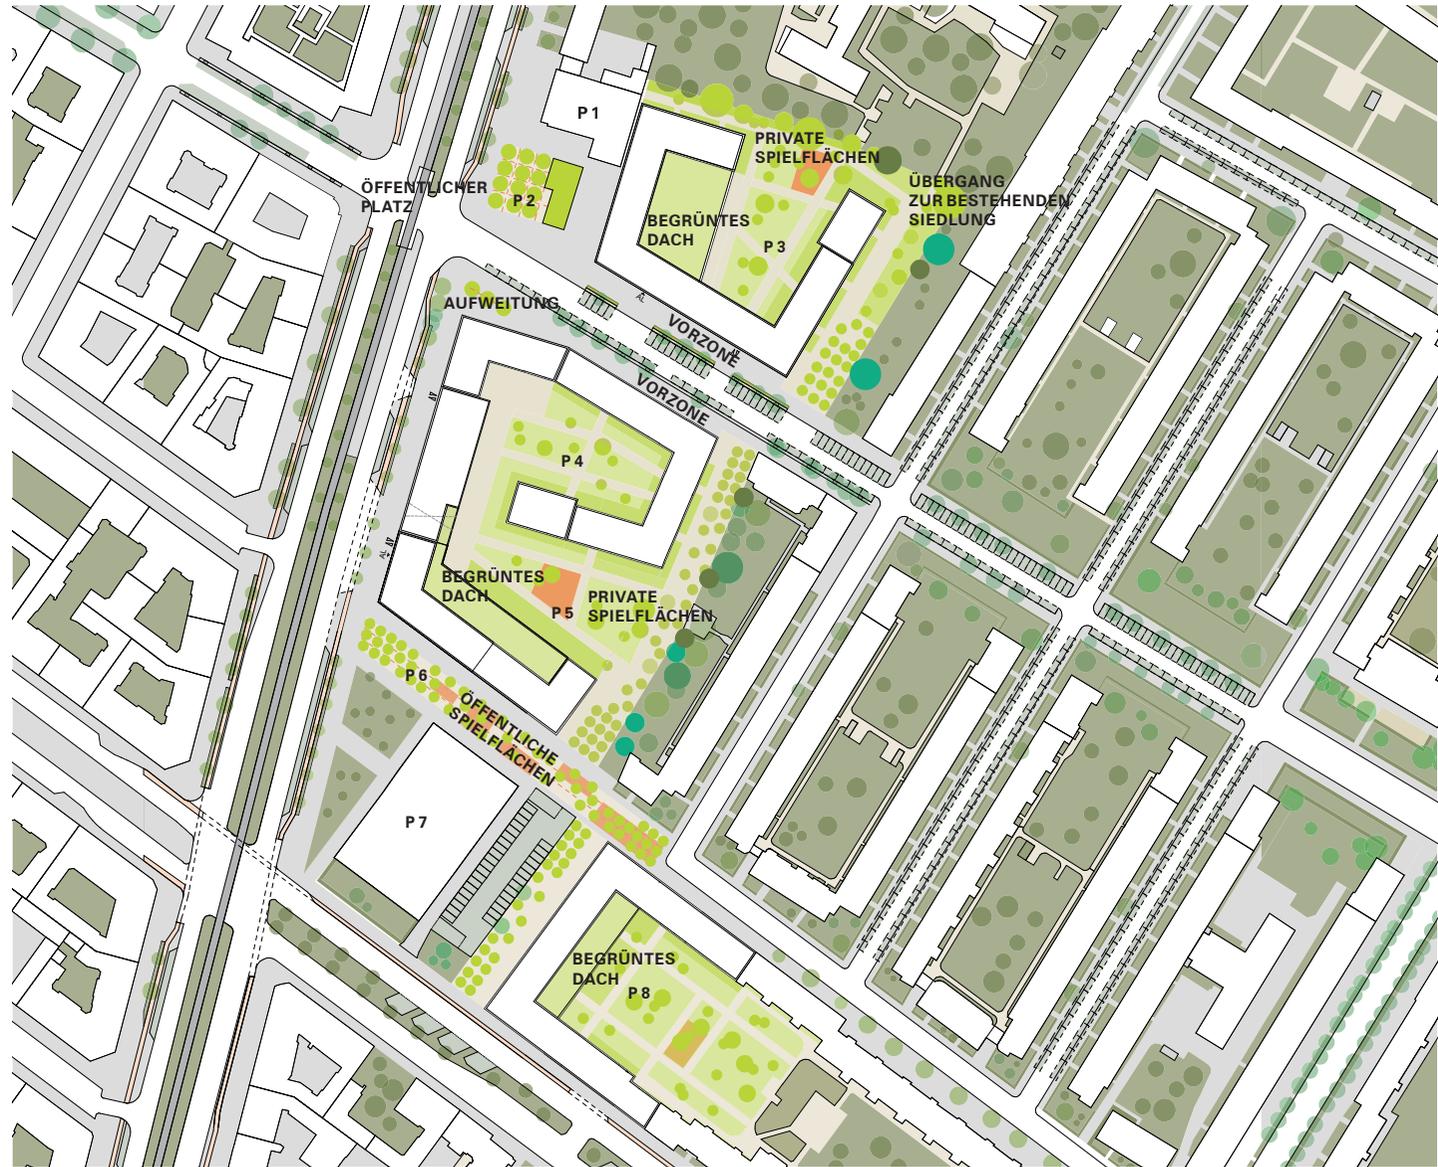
Variante A, Lageplan, Endfassung, o. M.
